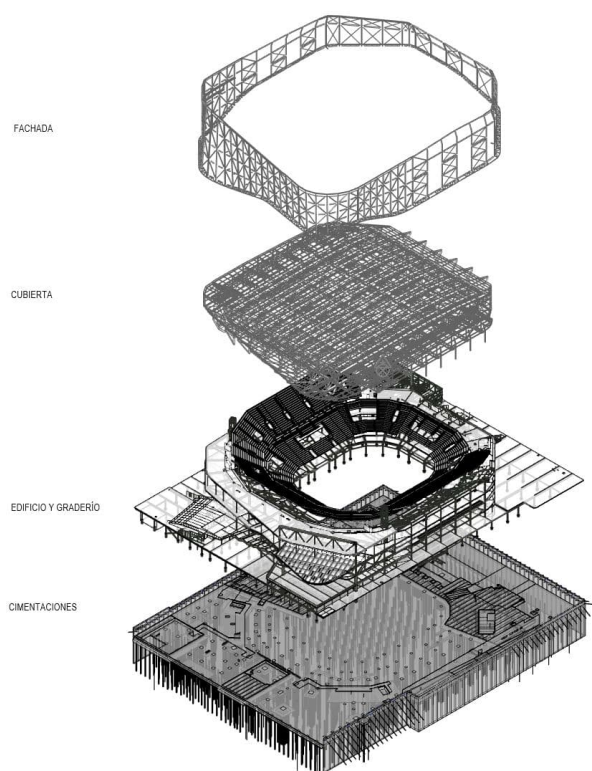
Imagen resumen de las partes en las que se divide el edificio a nivel estructural
